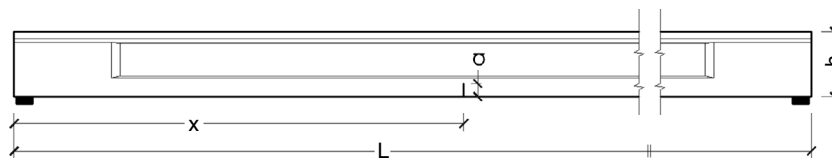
Vista longitudinal de la viga, con los parámetros de definición de la fisura.
